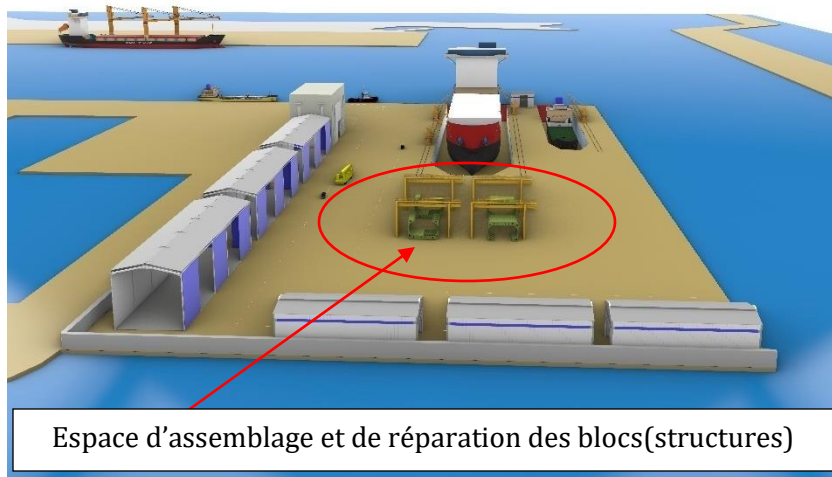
Plan N° 05 : Vue nord-est du chantier naval en 3D, avec les deux cales sèches et les différents ateliers.
